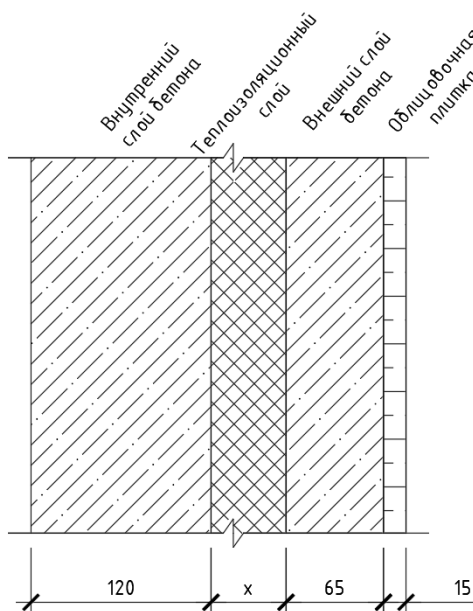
Пирог трехслойной стеновой железобетонной панели
